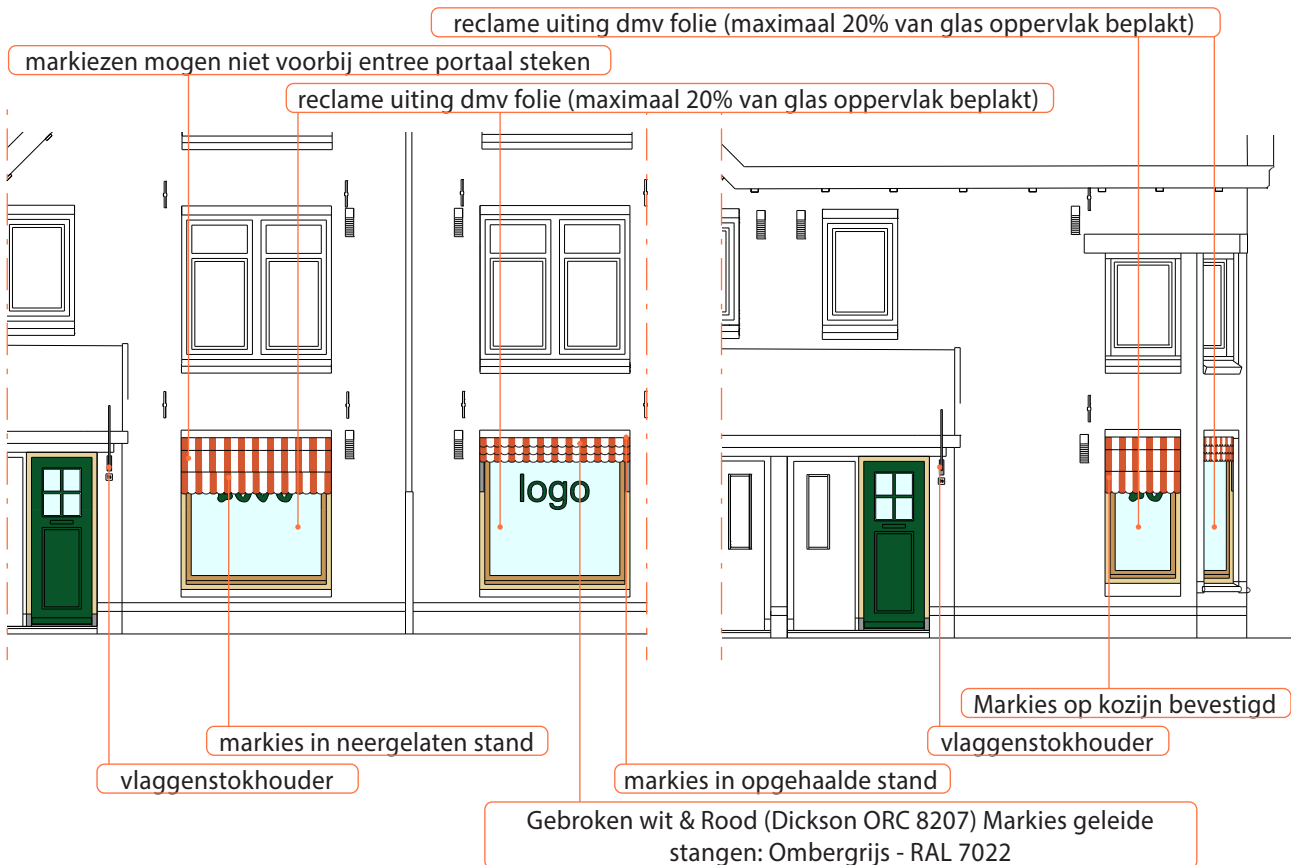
H.2 Gevel BOG ruimte lage blokken (3 lagen)
